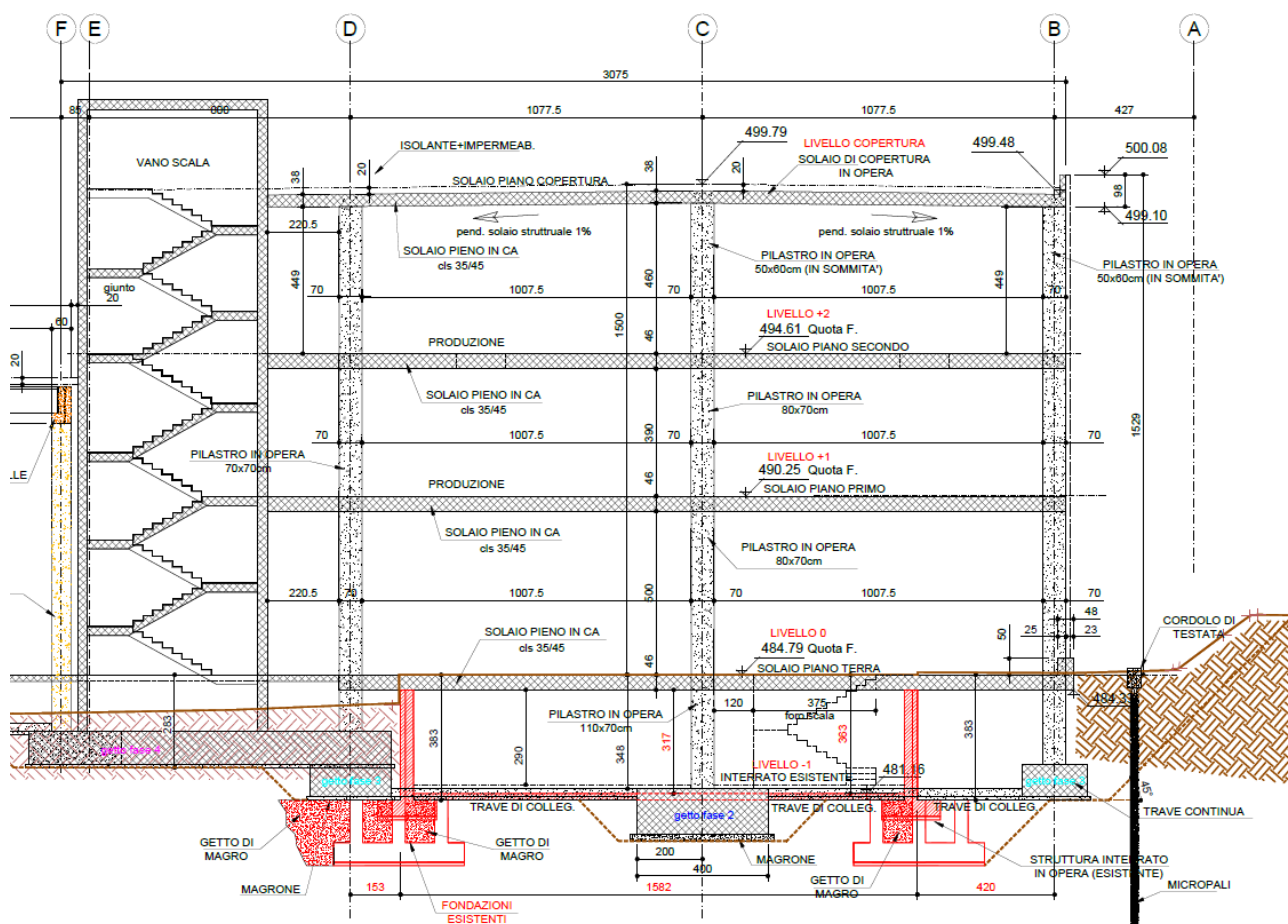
Sezione trasversale E-E – Fabbricato Ex. Piemonte
